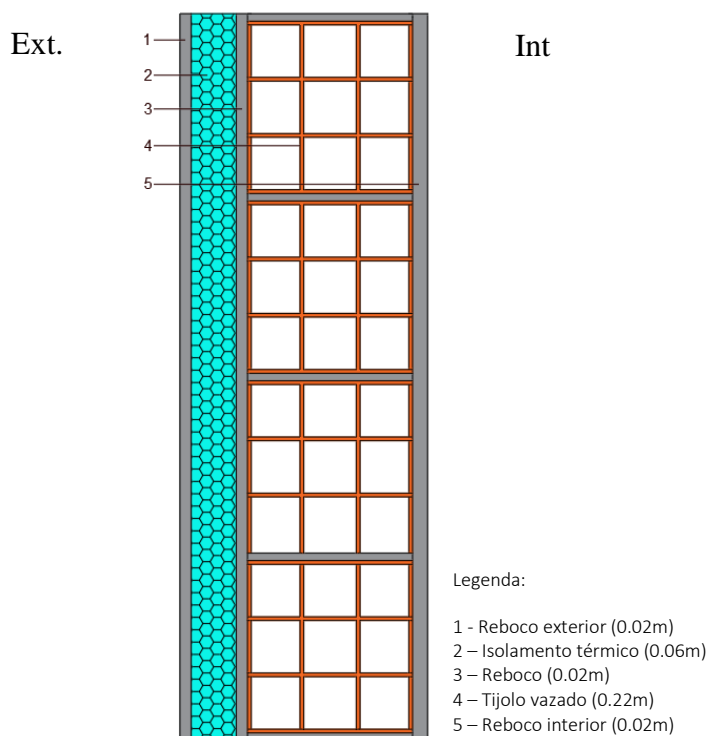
Pormenor construtivo referente à solução construtiva ETICS
